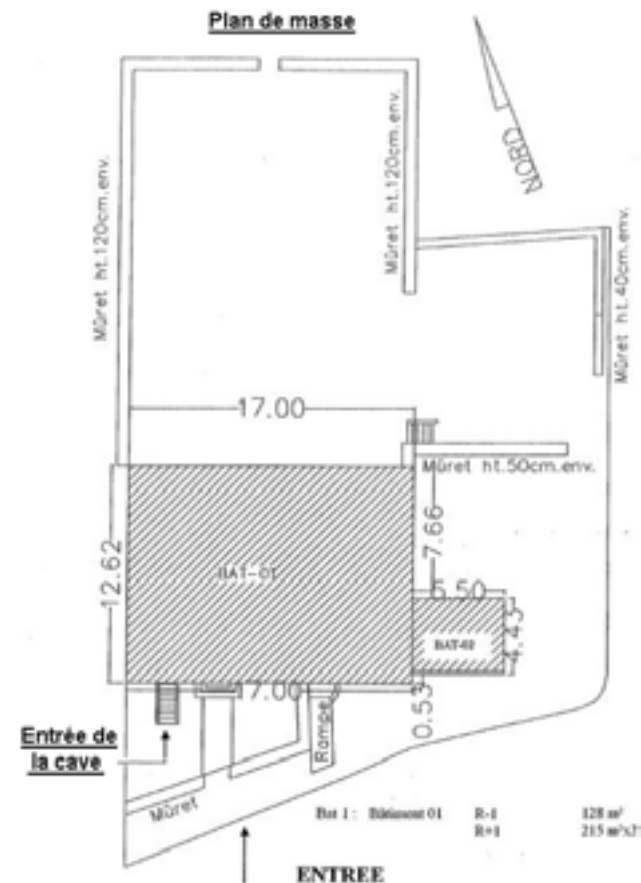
Plan de masse du bâtiment et localisation de l'entrée de la cave (Plan : CG 88)
